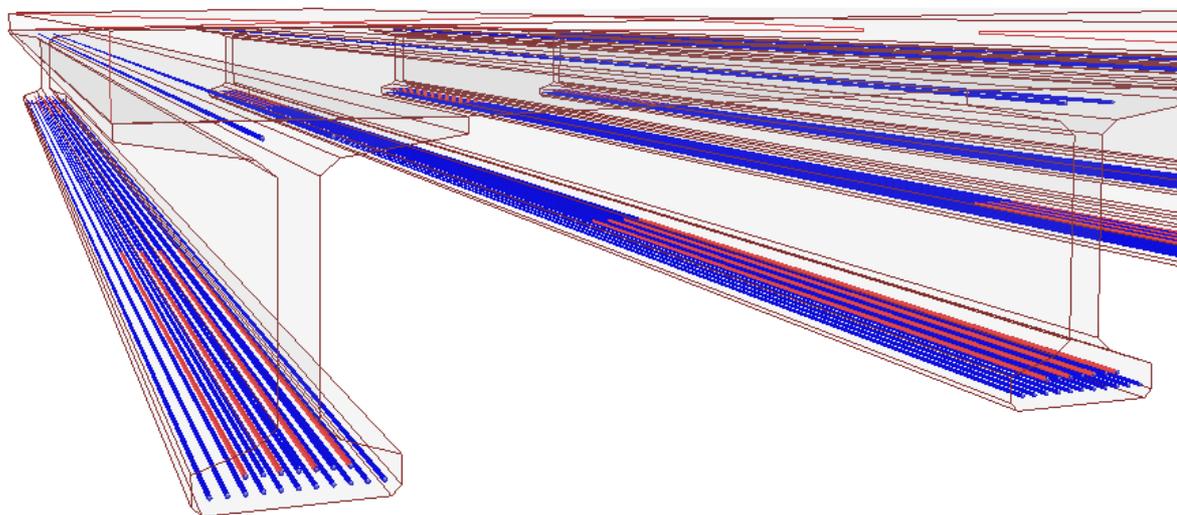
Vista esquemática de la armadura activa en el Tablero 2. Fuente: El. prop.
